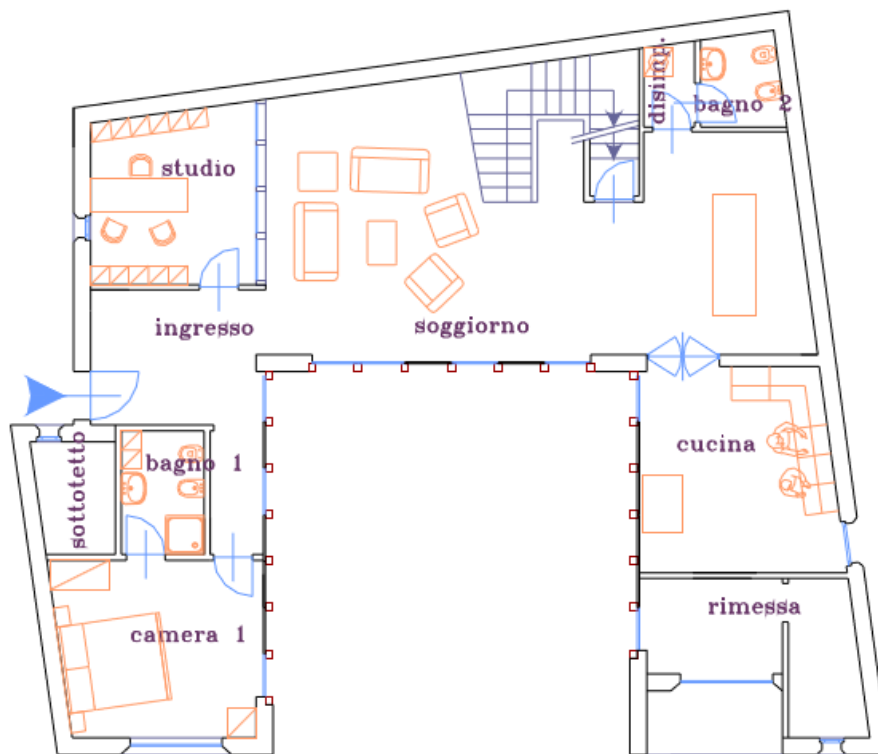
Pianta dell'abitazione presa in considerazione
